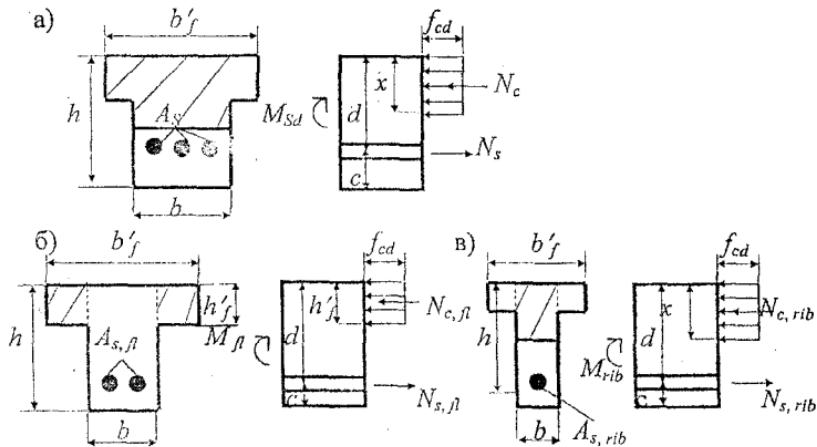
К расчету тавровых сечений (случай второй)
